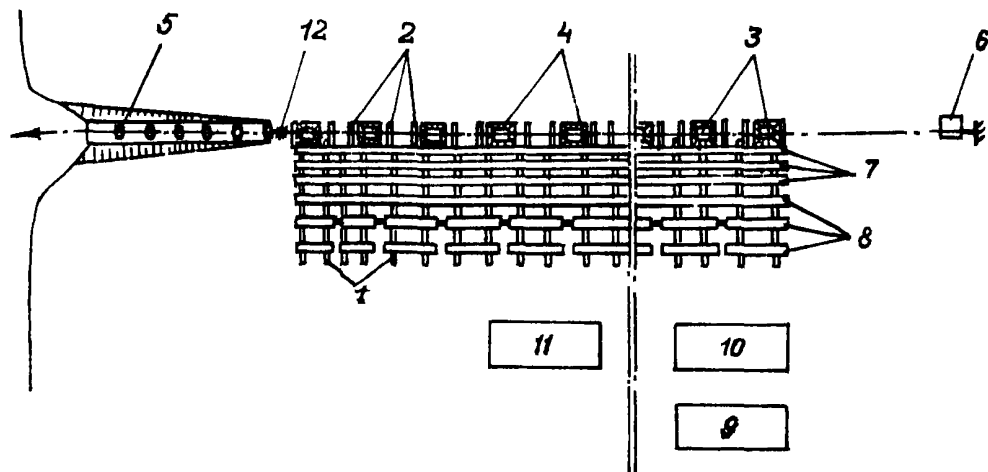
Технологическая схема заготовки секций и плетей для сварки:
